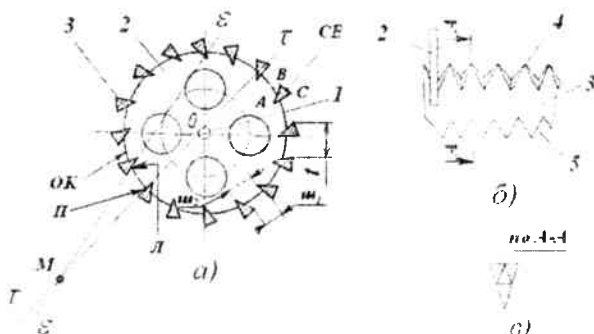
Каток, снабженный двусторонне зубчатыми планками:
